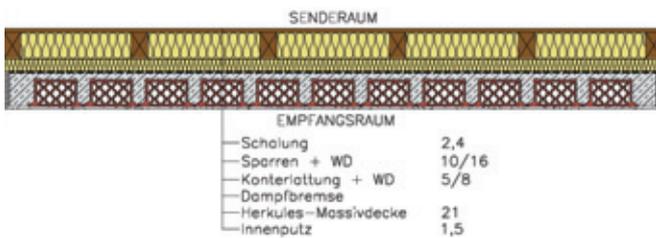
Massive Decke (Ziegeldecke) mit Dachaufbau (ohne Deckung)
